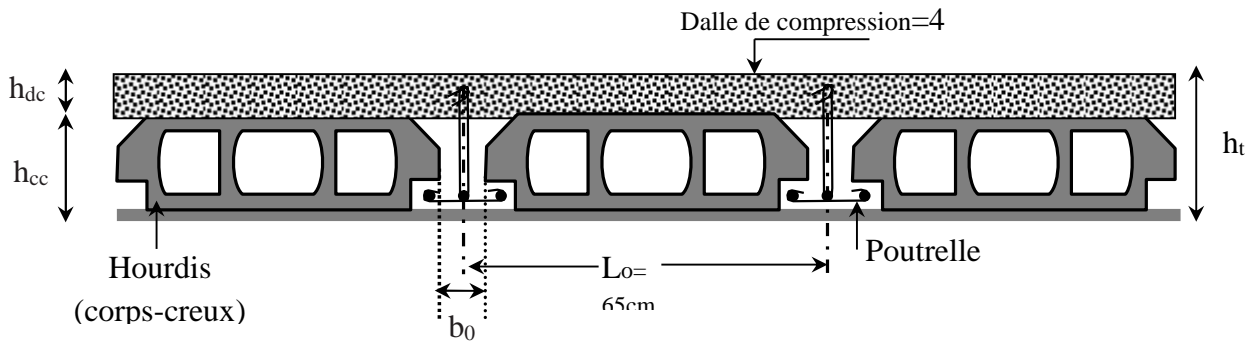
Coupe transversale d'un plancher à corps creux
